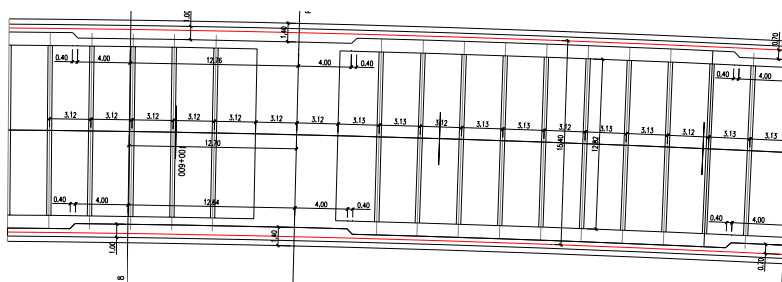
Planta de vão do tabuleiro do Viaduto del Llobregat – Barcelona
